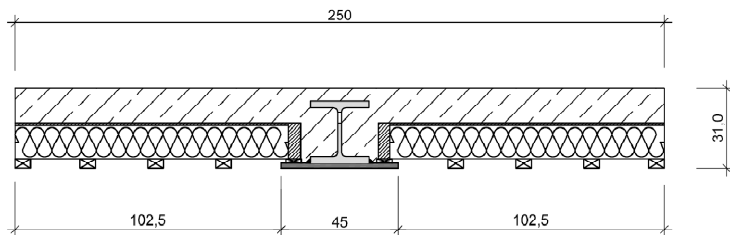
Versuchsquerschnitt Slim-Floor Träger mit Cofradal200®-Elementen
